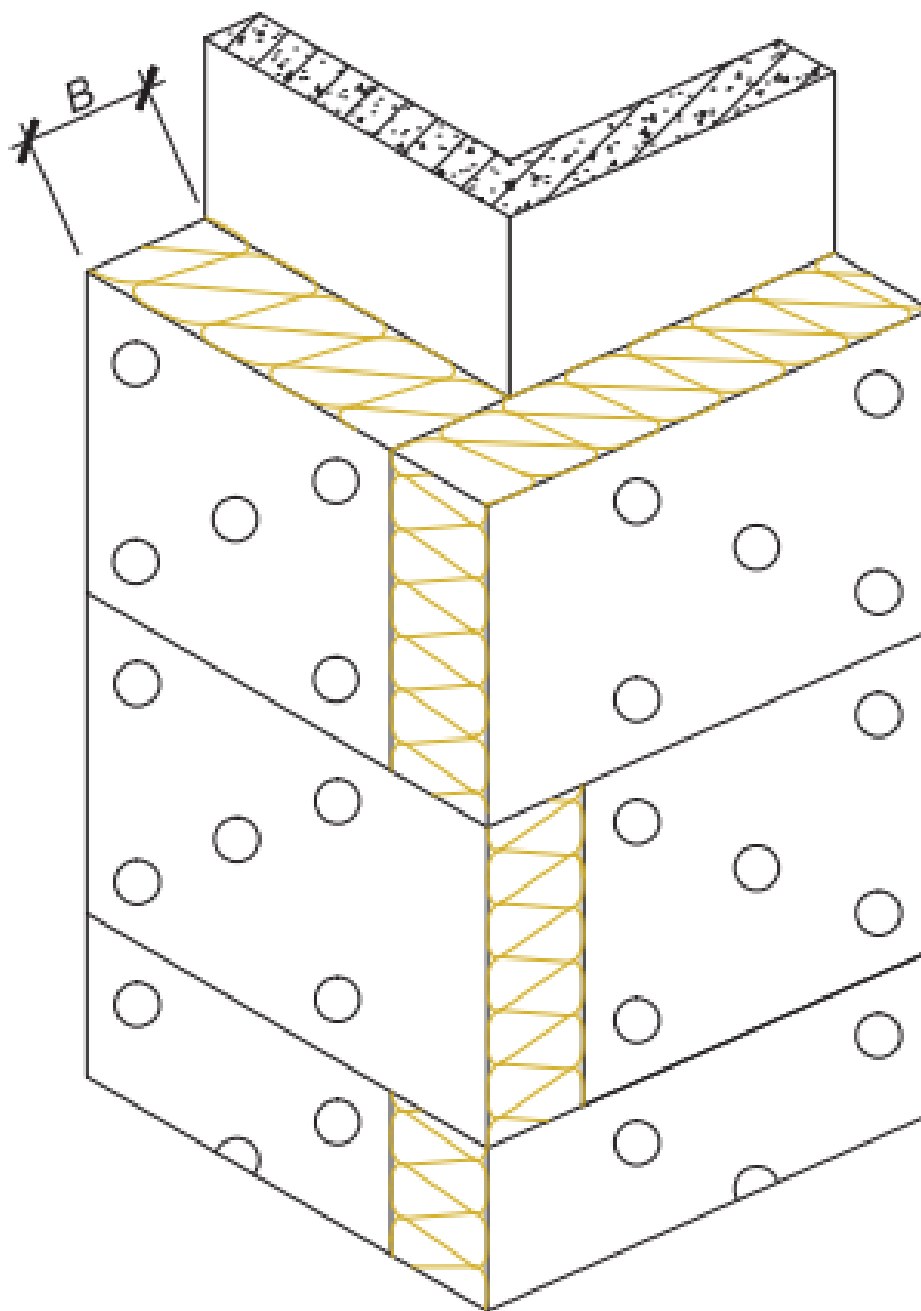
Схема кріплення утеплювача на кут будівлі
